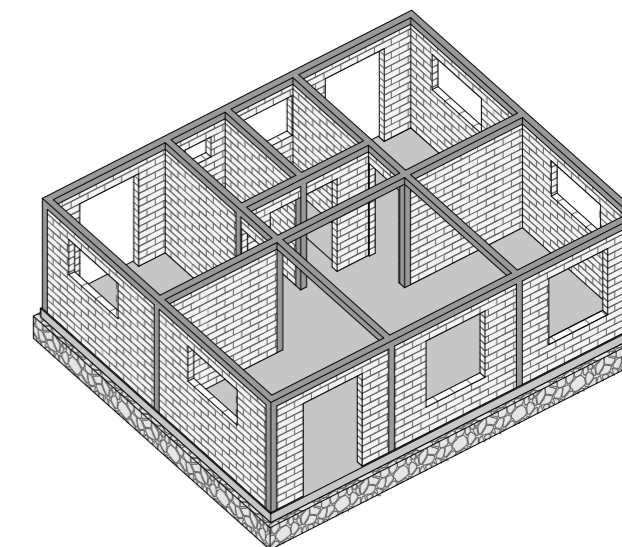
Axonometría de mampostería confinada con bloque de hormigón
